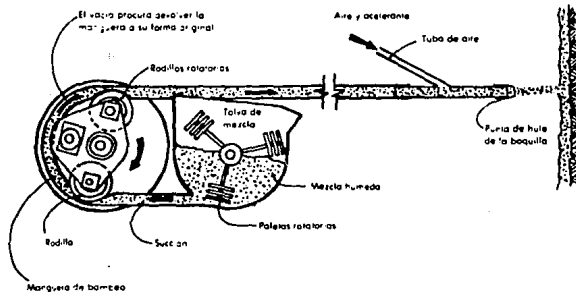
Funcionamiento característico de una máquina para concreto lanzado de mezcla húmeda.
